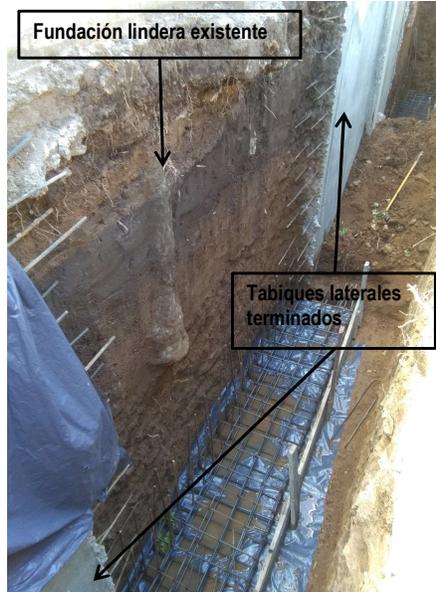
Excavación intermedia y armadura de zapata corrida + esperas de tabique vertical
